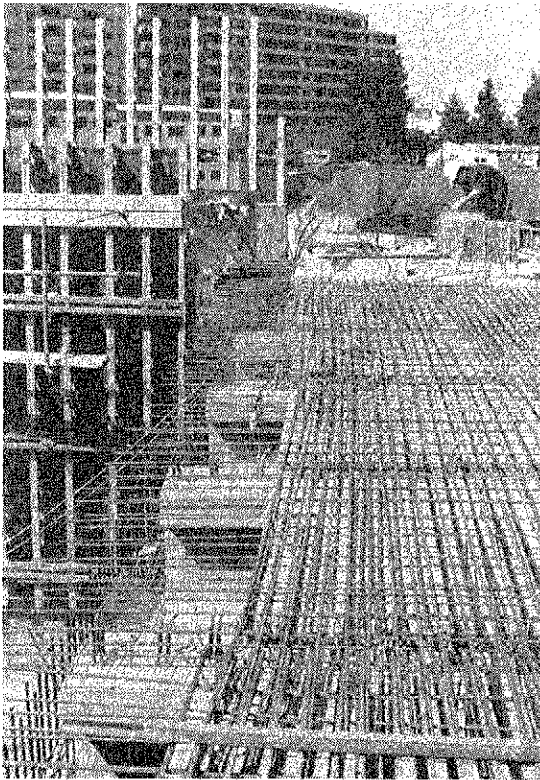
Vigas longitudinales, placas y armadura losa compresión.
